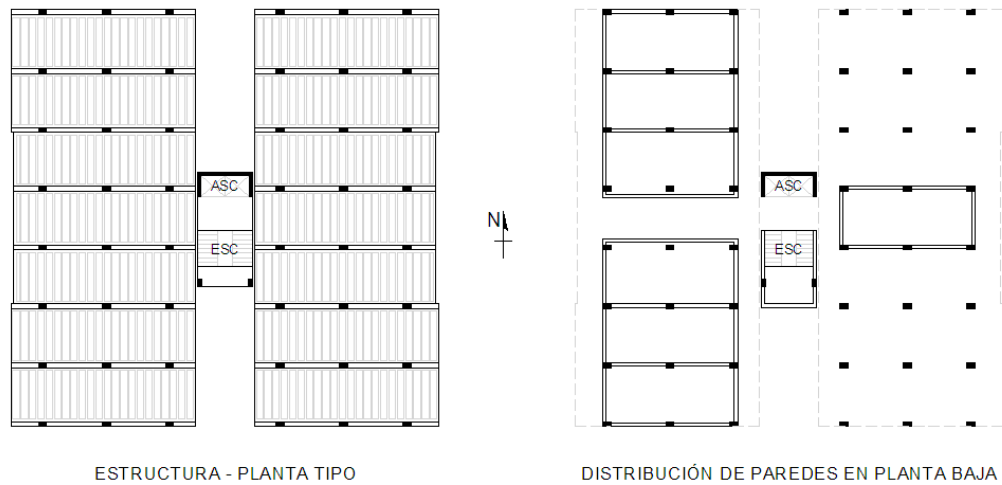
Edificio Palace Corvin, plantas y corte de la estructura
